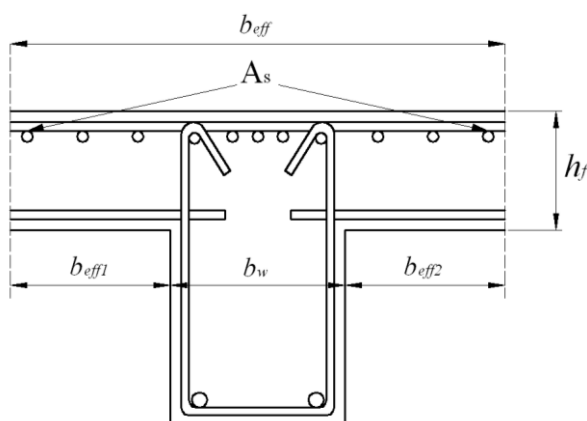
Расположение растянутой арматуры неразрезных балок в сечении полки
